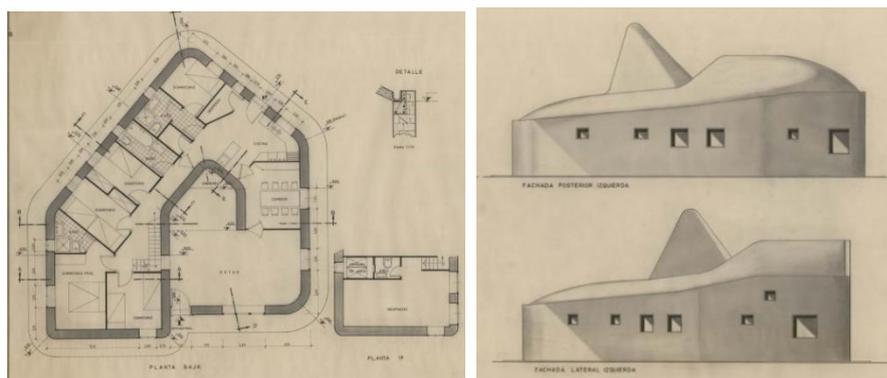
Casa en El Paular. Plantas y alzados. Fondo Inza
